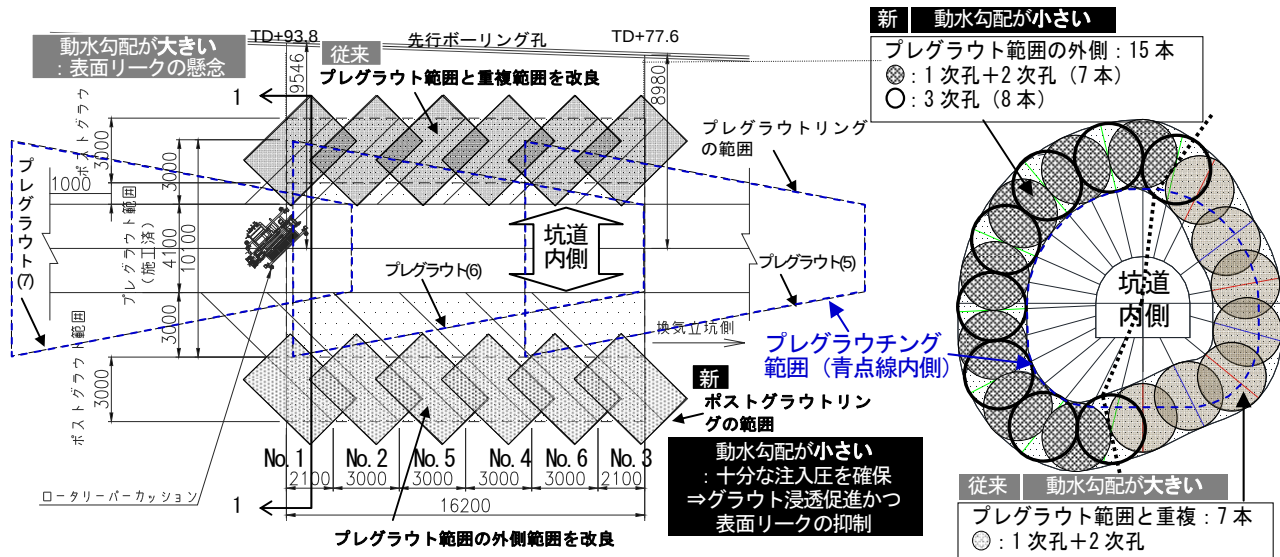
ポストグラウチングのリング配置図 (左：平面図, 右：横断面図 (1-1断面))
